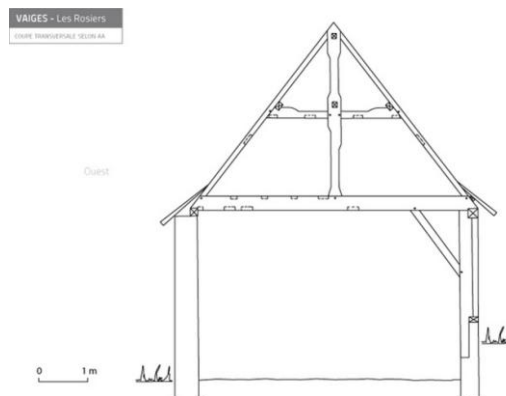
Charpente de type mixte, sur poteaux : les Rosiers à Vaiges, coupe transversale. © Dessin L. Cohin.
